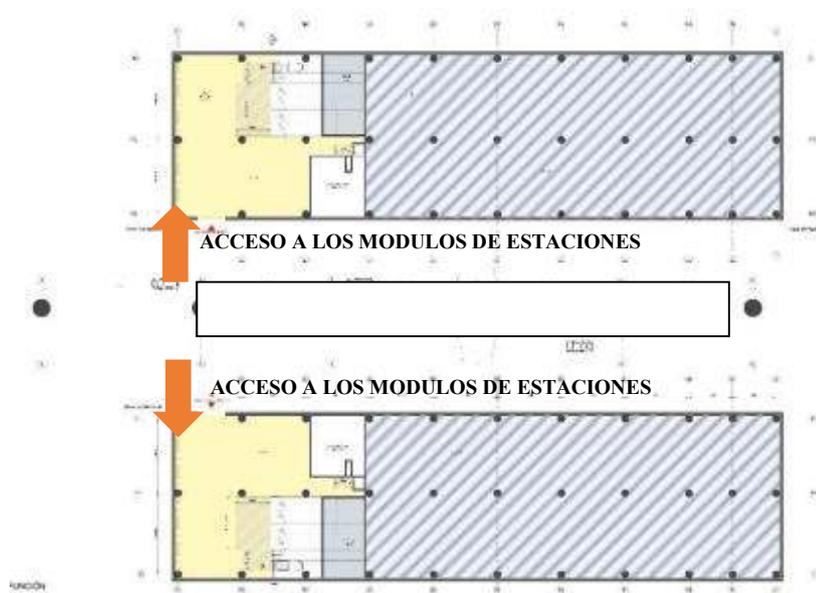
Planta baja de una estación sencilla. Fuente: Elaboración propia
